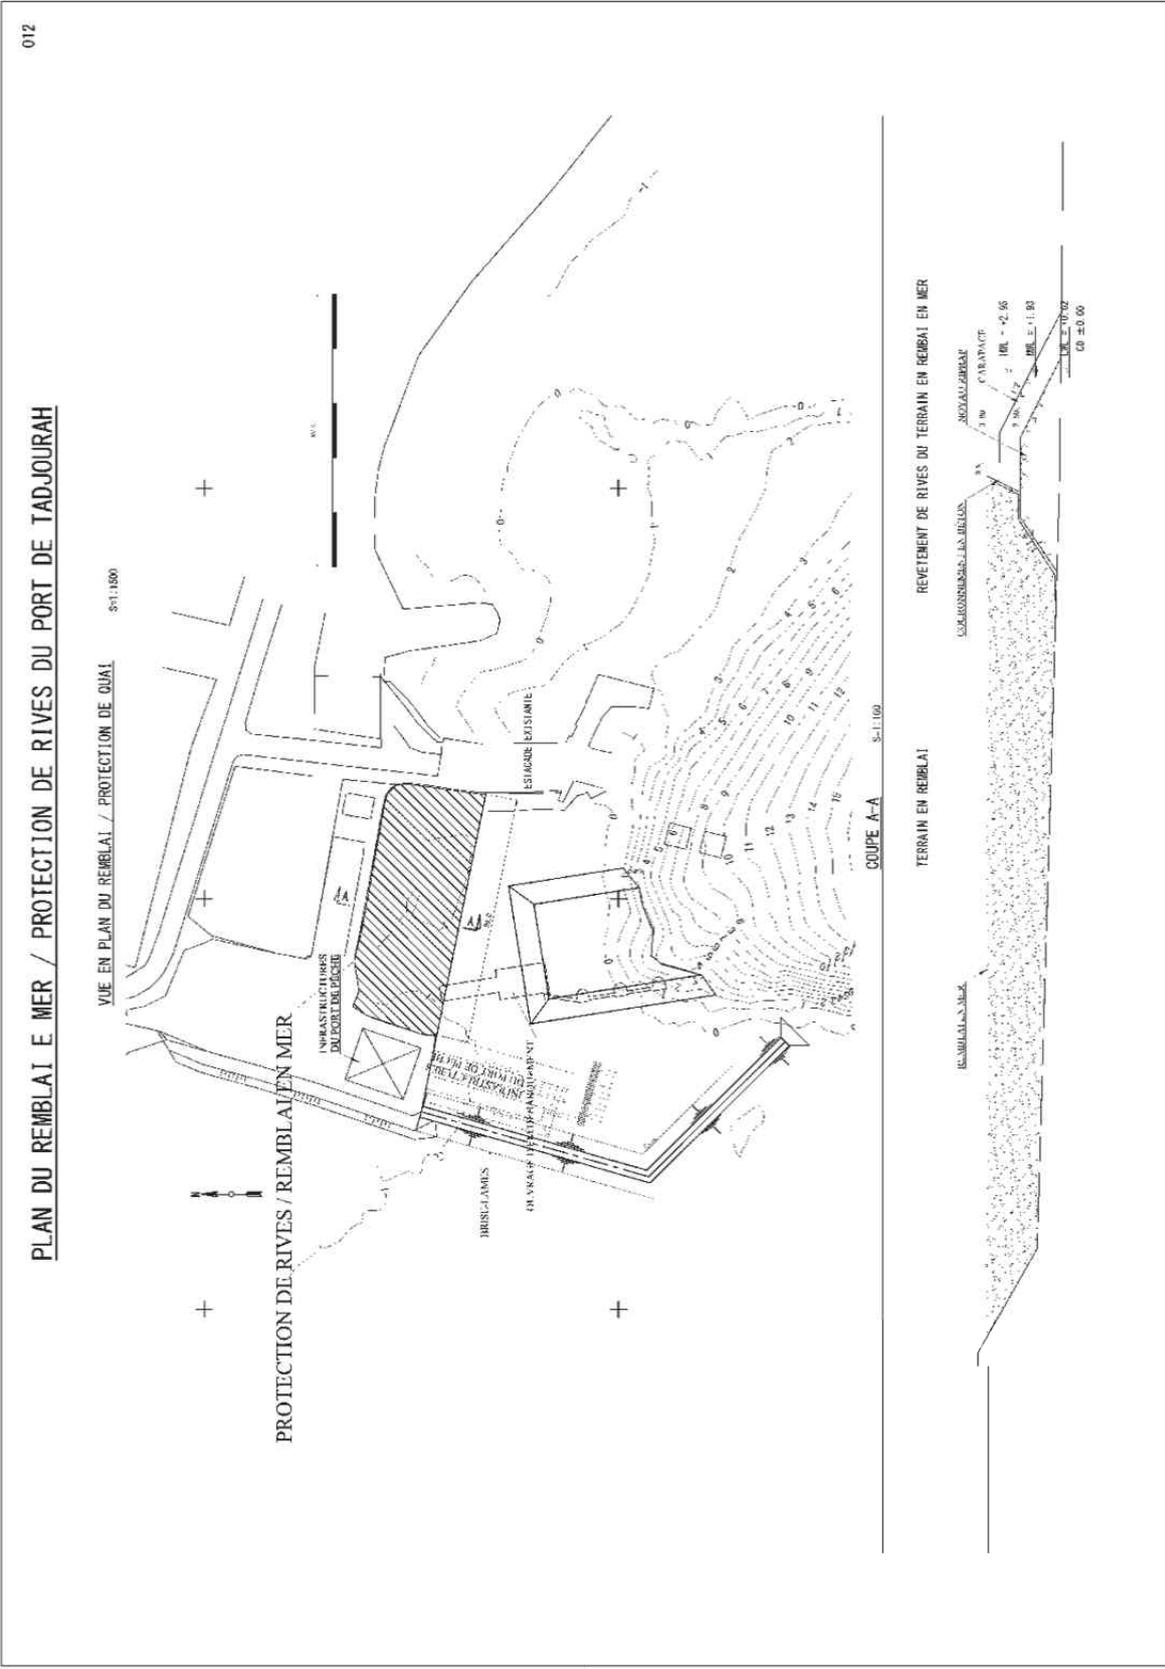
Plan du revêtement de rives du remblaiement en mer du Port de Tadjourah
